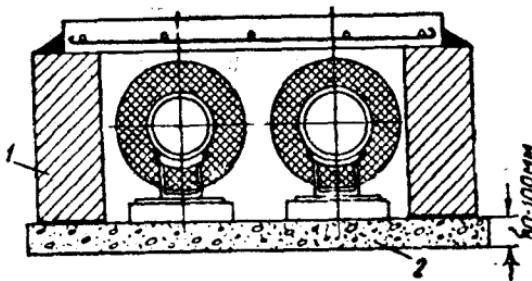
磚砌裝配式鋼筋混凝土蓋板的標準管溝
